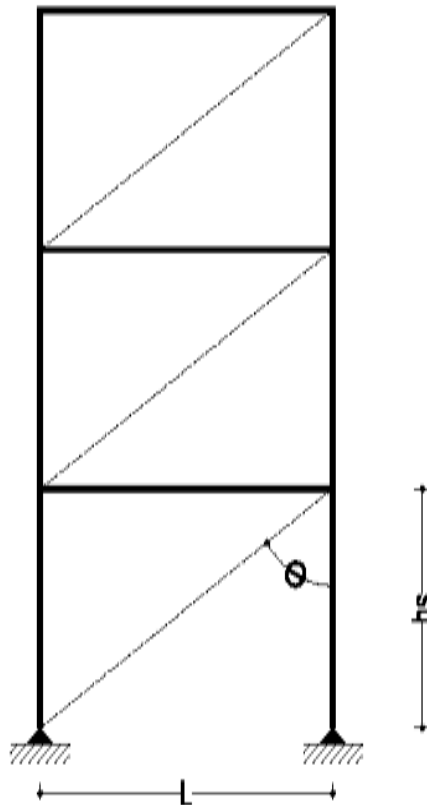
Steel Plate Shear Wall* (Berman dan Bruneau, 2003).
